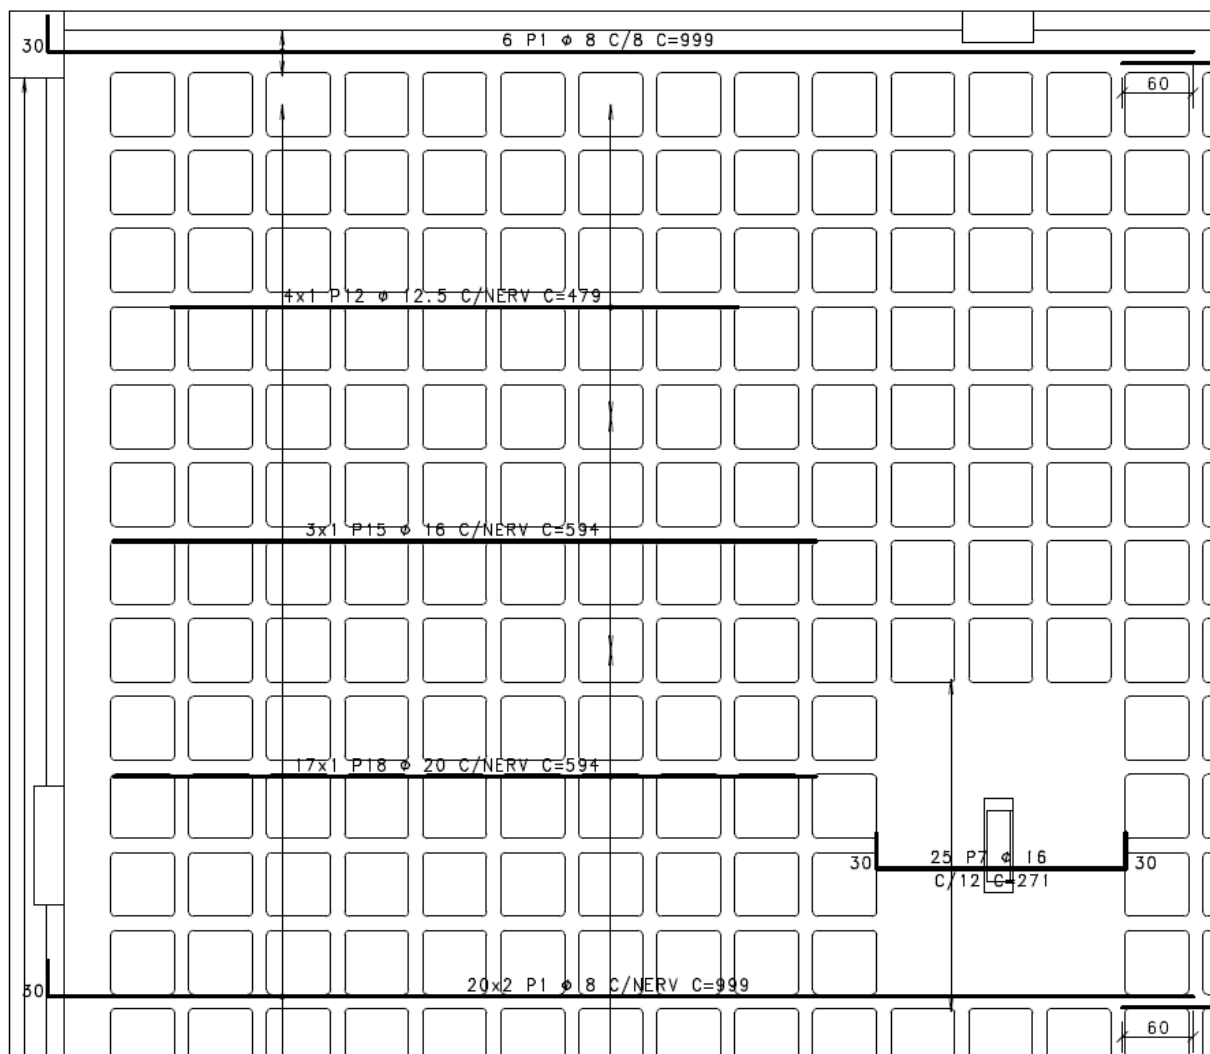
10 - Detalhe das armações positivas horizontais do primeiro pavimento.
